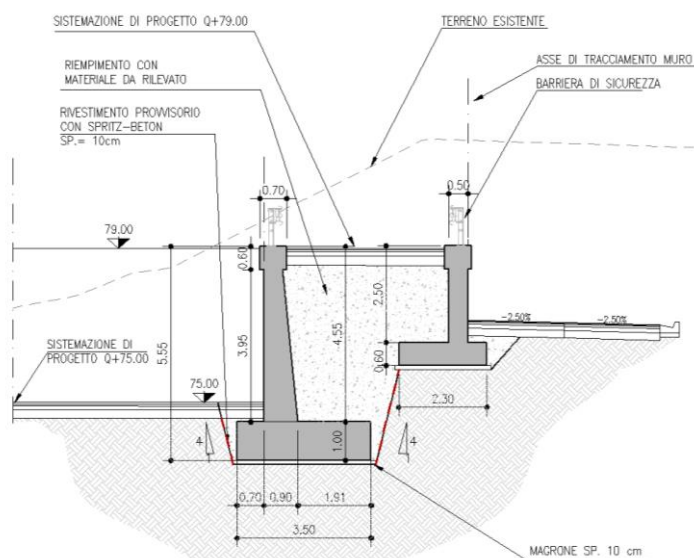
Muro di sostegno MS03 – Sezione tipo 2
